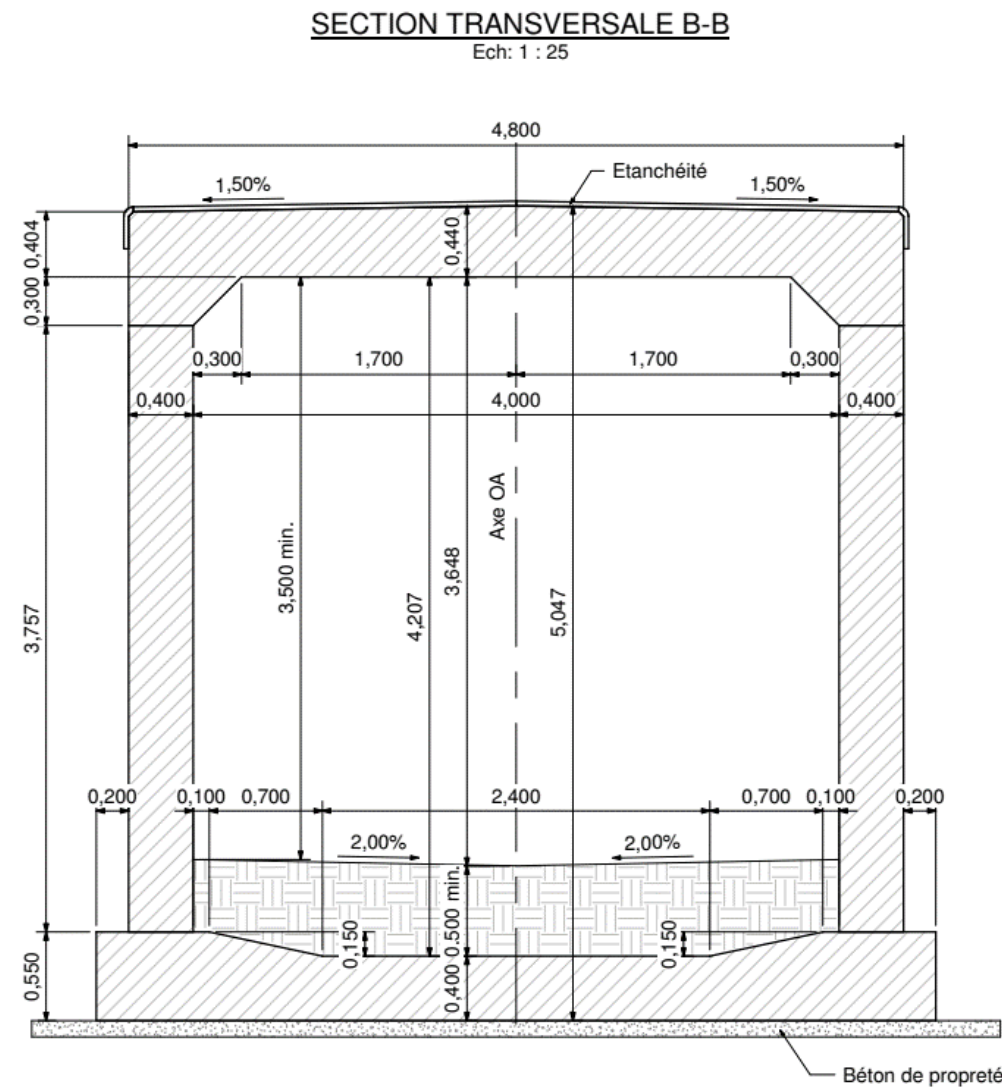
PROFIL EN TRAVERS DU BOVIDUC DE BAS-VILLIERS (SOURCE : EGIS, 2023)
